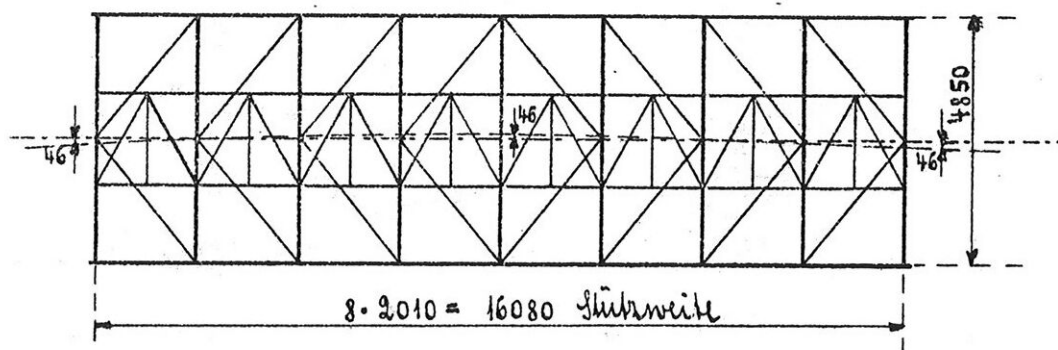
Grundriss der Trattenbachbrücke
